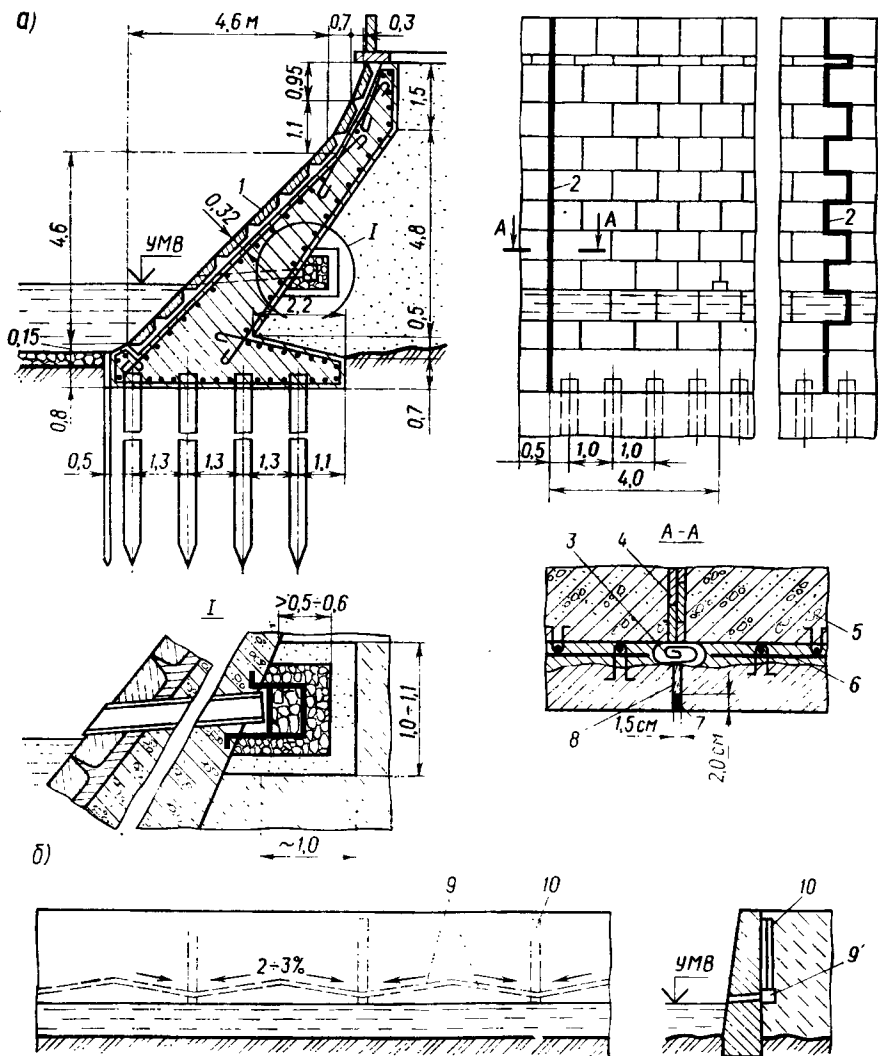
Конструкция подпорной стены из монолитного железобетона:
